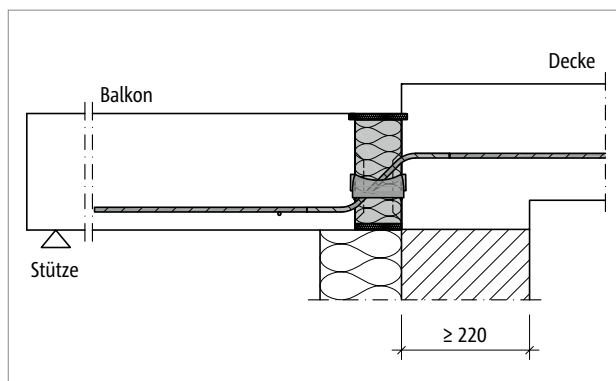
Schöck Isokorb® T Typ QL: Einbausituation mit kleinem Höhenversprung
